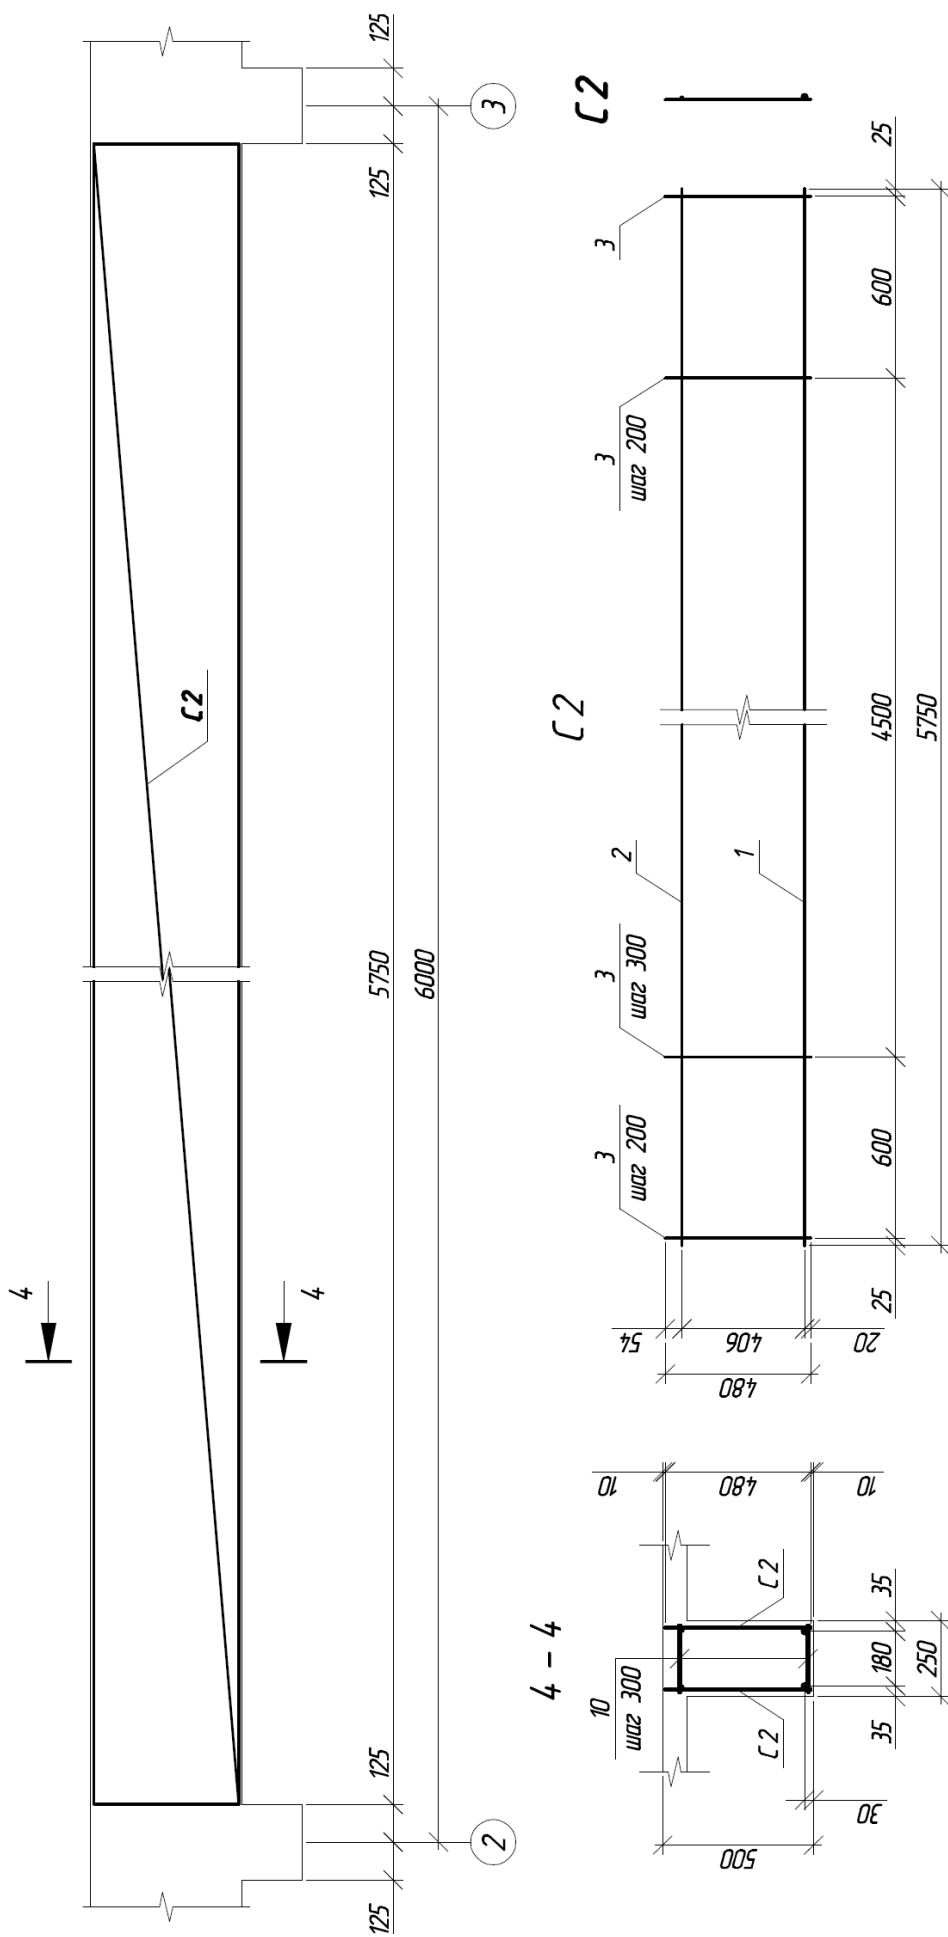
Схема армирования среднего пролета второстепенной балки
